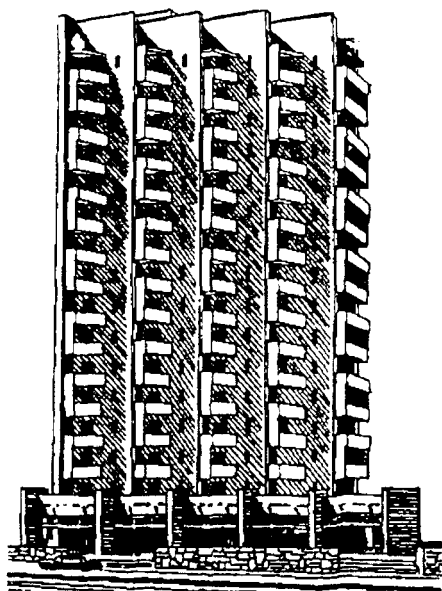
Многоэтажный жилой дом из монолитного железобетона в Баку.
